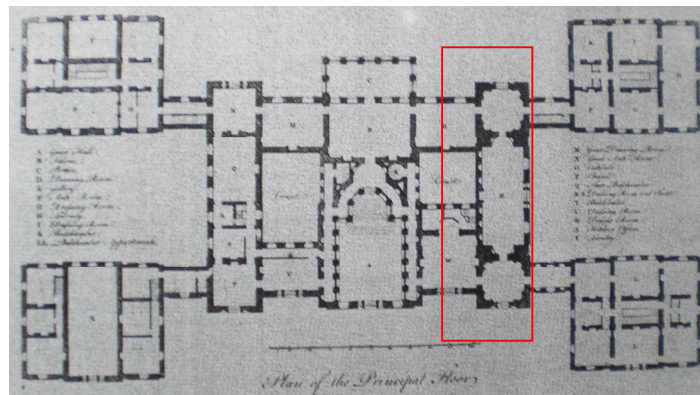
Holkham Hall, Grundriss (rot hervorgehoben ist die Galerie)
